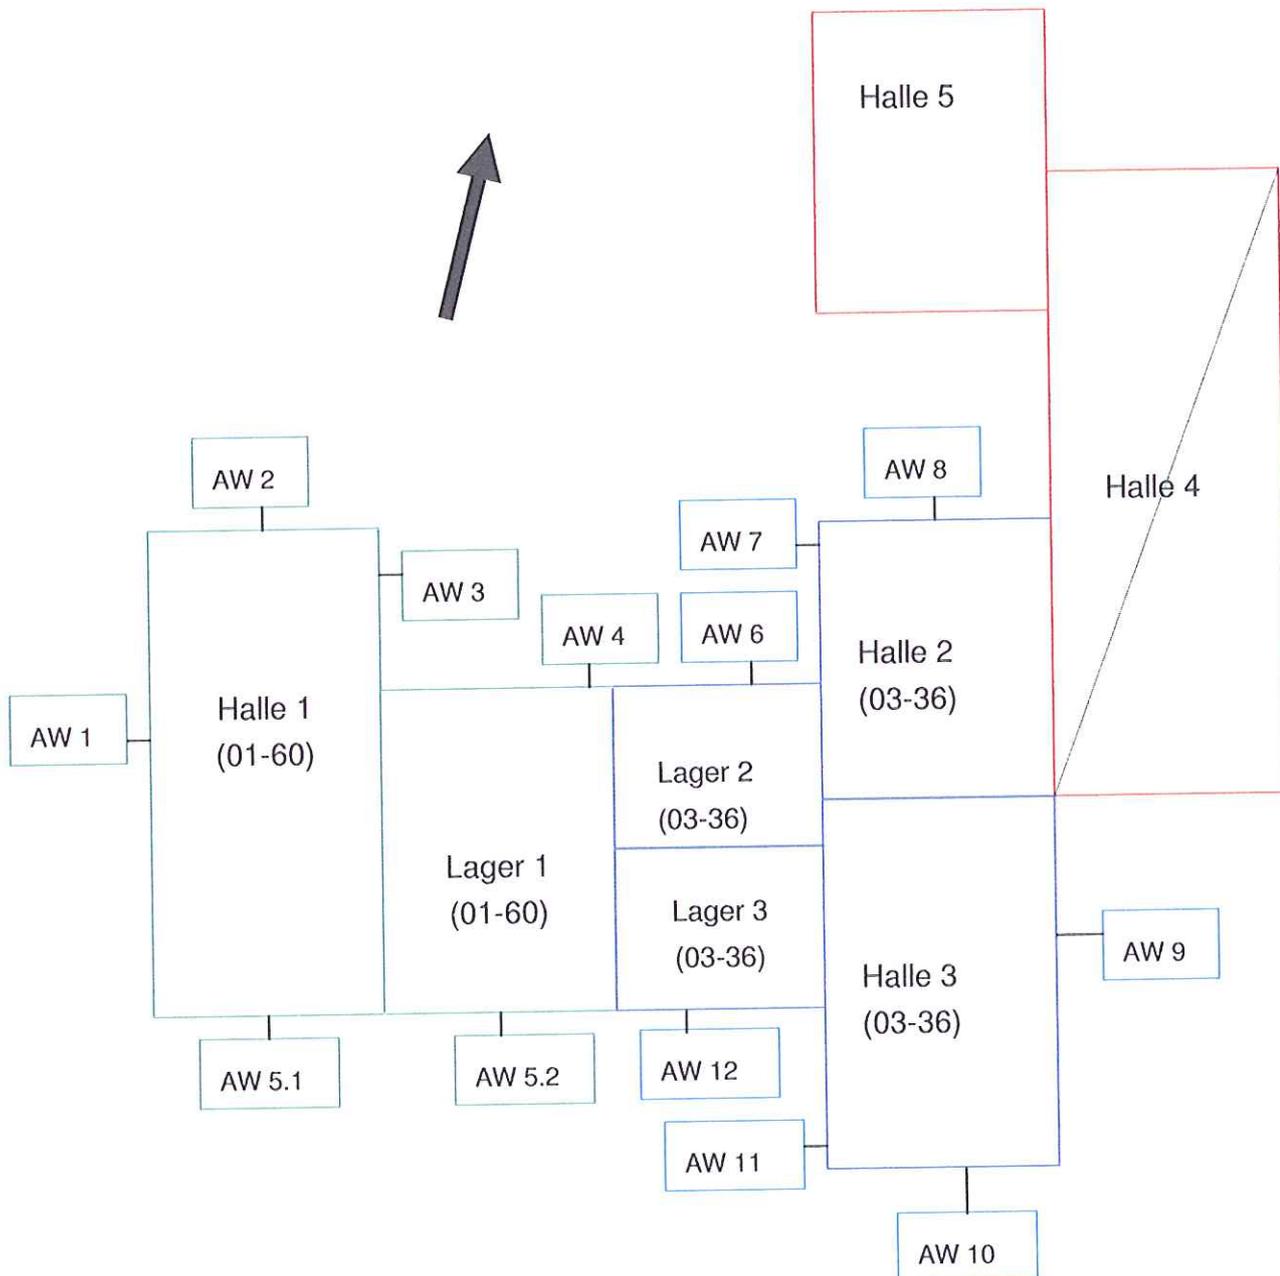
vorhandene Halle - Produktion 1 (01-60), Produktion 2/3 (03-36) und geplante Hallen 4 + 5 östlich des Grundweges - Bezeichnungen
